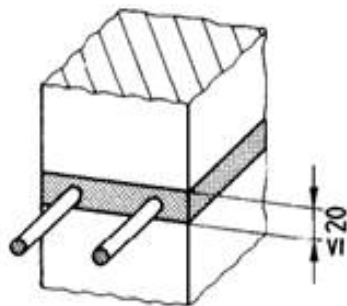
Horizontale Bewehrung in den Lagerfugen.
